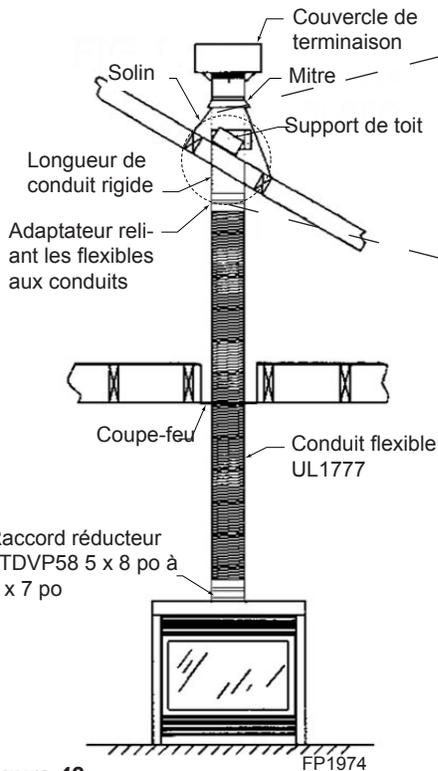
Installation typique d'un conduit de ventilation flexible vertical
